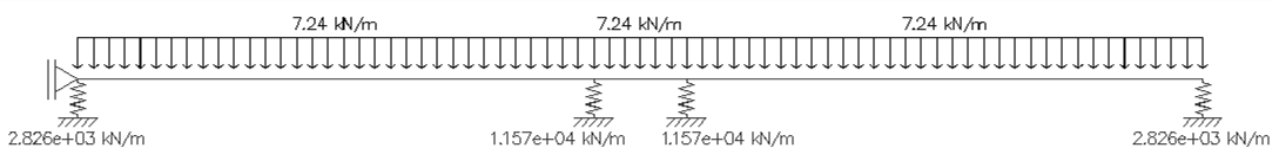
11 – Esquema estrutural do pavimento para determinação dos esforços em seu plano.
